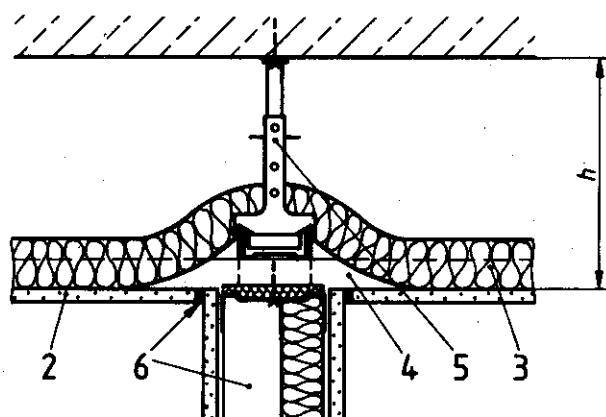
Trennwandanschluß an Unterdecke mit Trennung der Decklage
